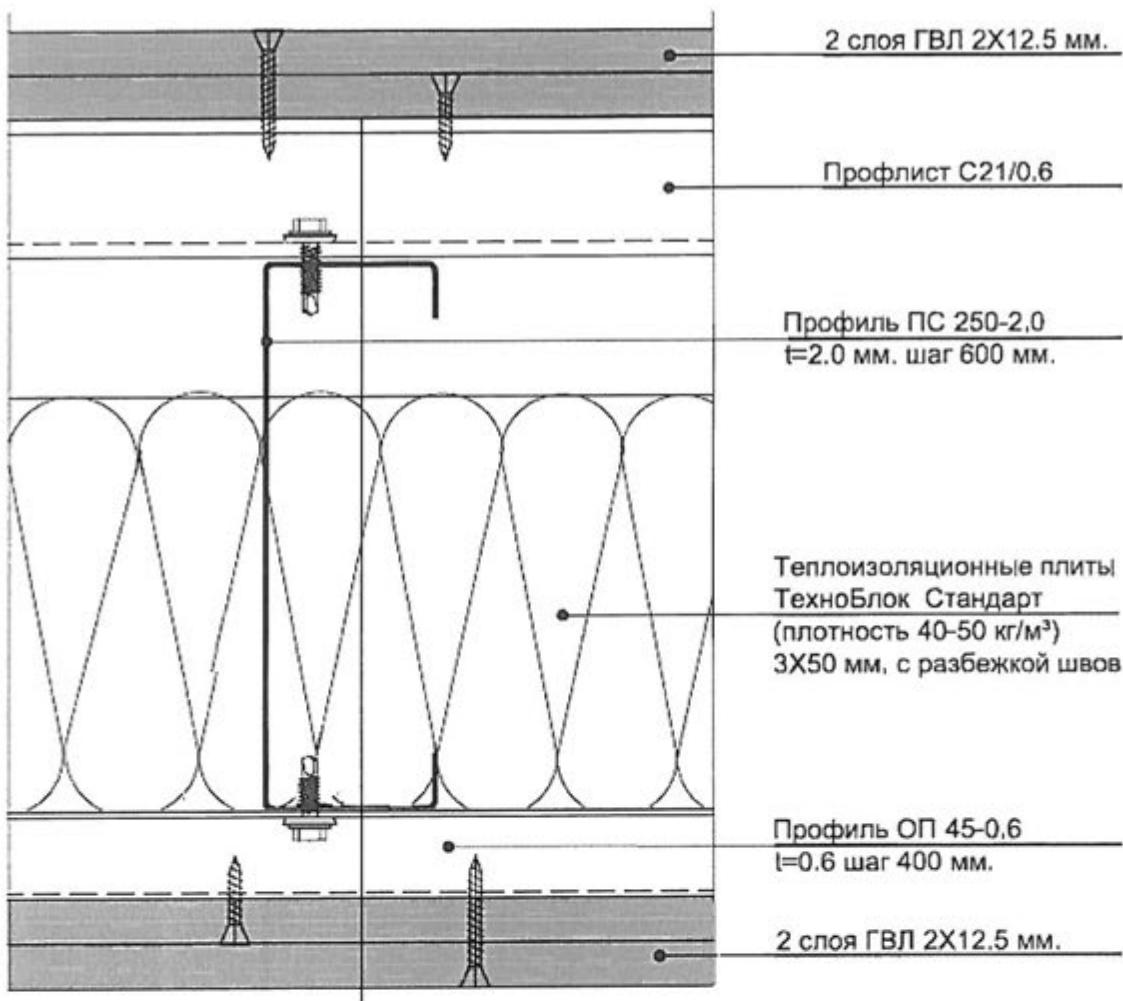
Схема конструктивного исполнения междуэтажного перекрытия (вариант 2).
